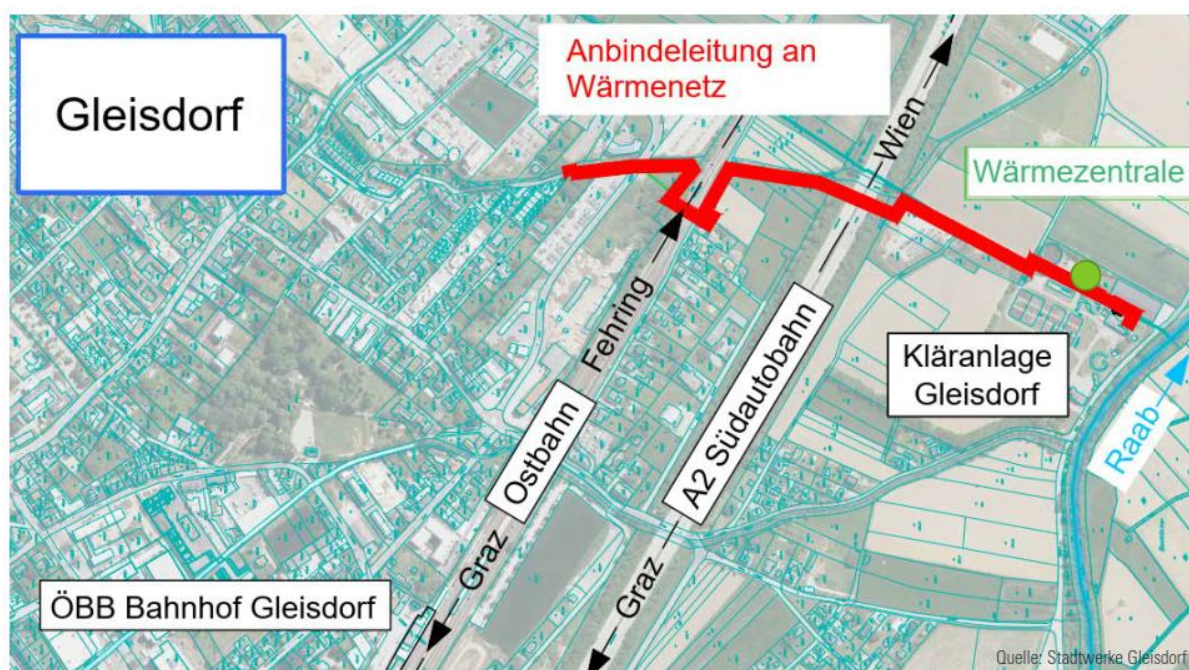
Lageplan Versorgungsleitung ARA - Fernwärmenetz
